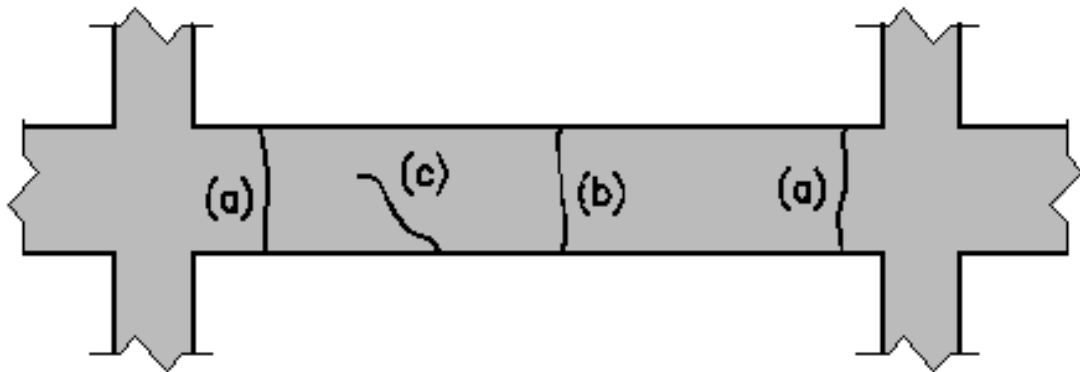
Grietas de Flexión (a,b) y corte (c).
